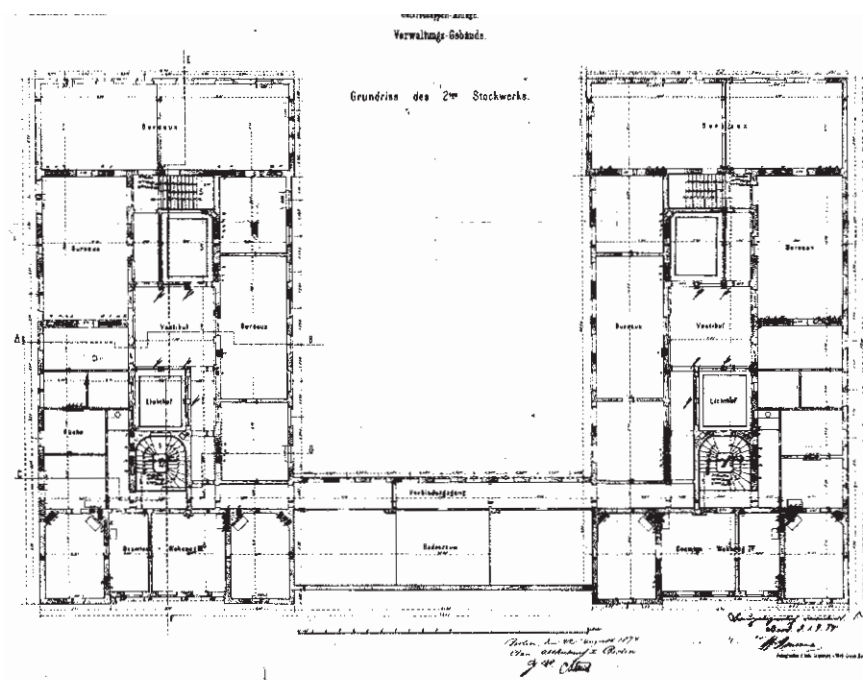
Historischer Grundriss Anhalter Güterbahnhof, 2. Obergeschoss
